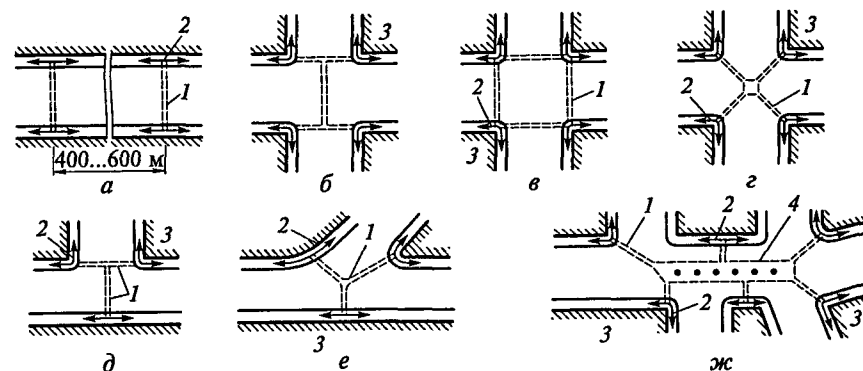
Планировочные схемы пешеходных тоннелей по трассе магистралей (а), на прямом пересечении (б—г), примыкании (д, е) магистралей и на площади (ж):
